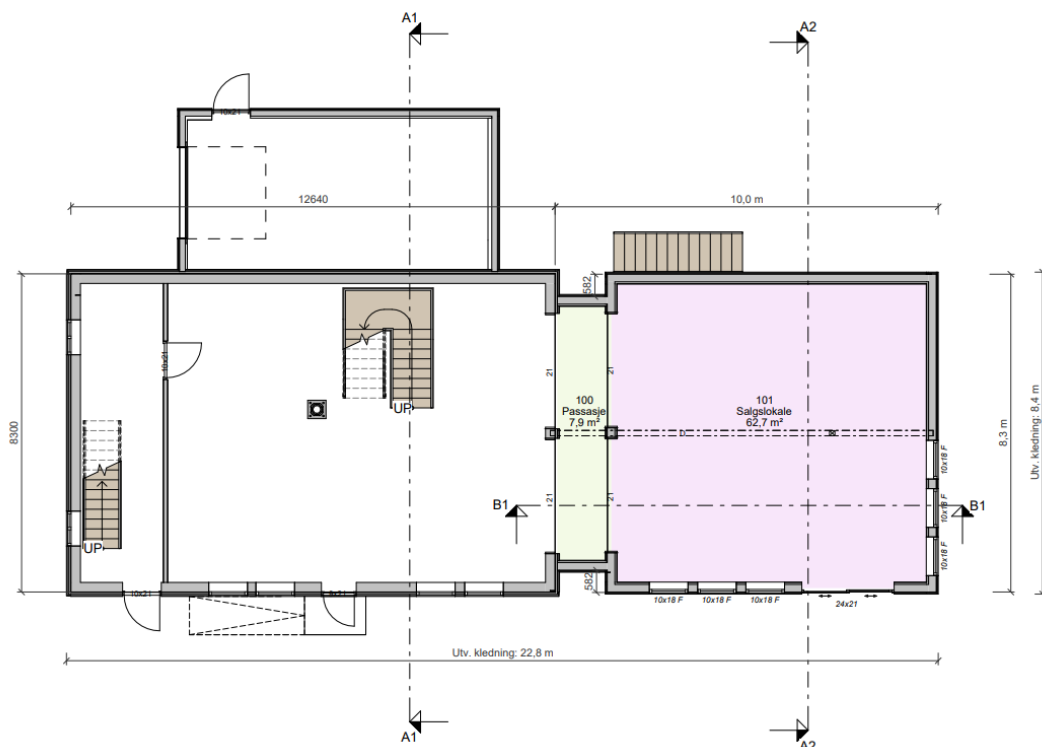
Utkast til plan for 1.etasje viser 10 m forlengelse av bygning til salgslokaler.
